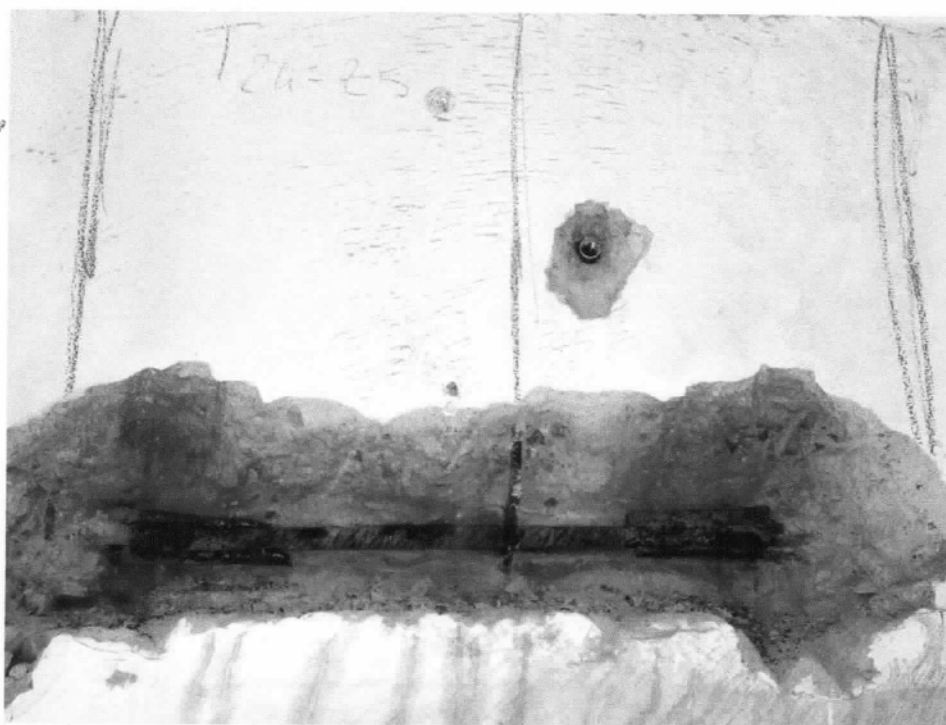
Estrazione della barra di armatura FTP 24-25 dalla trave TP24-25
